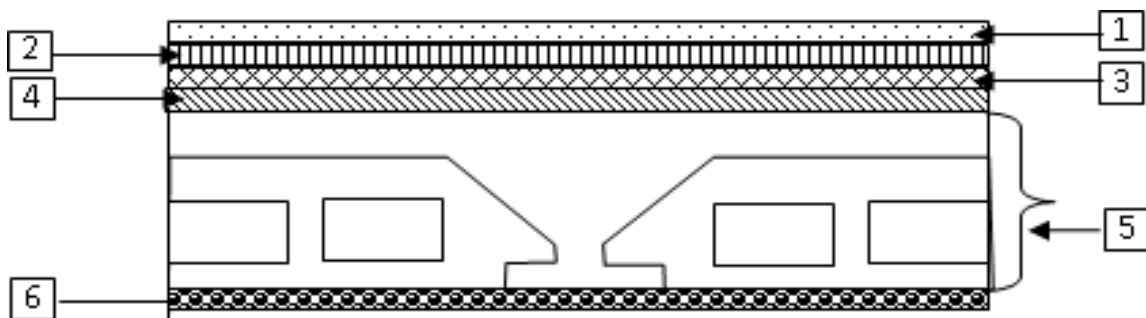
Coupe transversale d'un plancher terrasse inaccessible.
